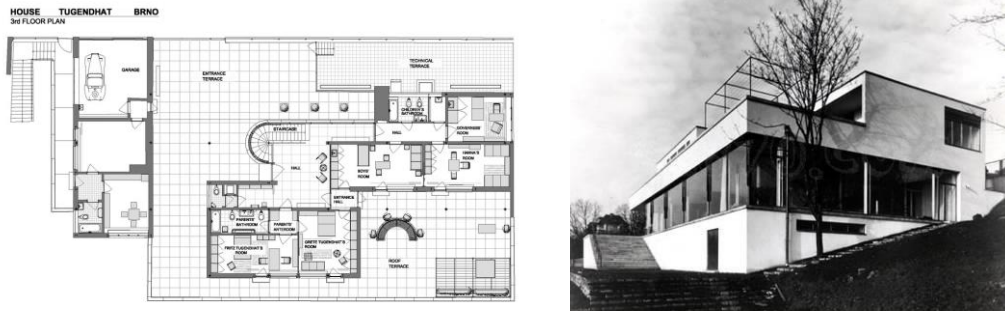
Planta y fachada de la casa Tugendhat de Mies.
